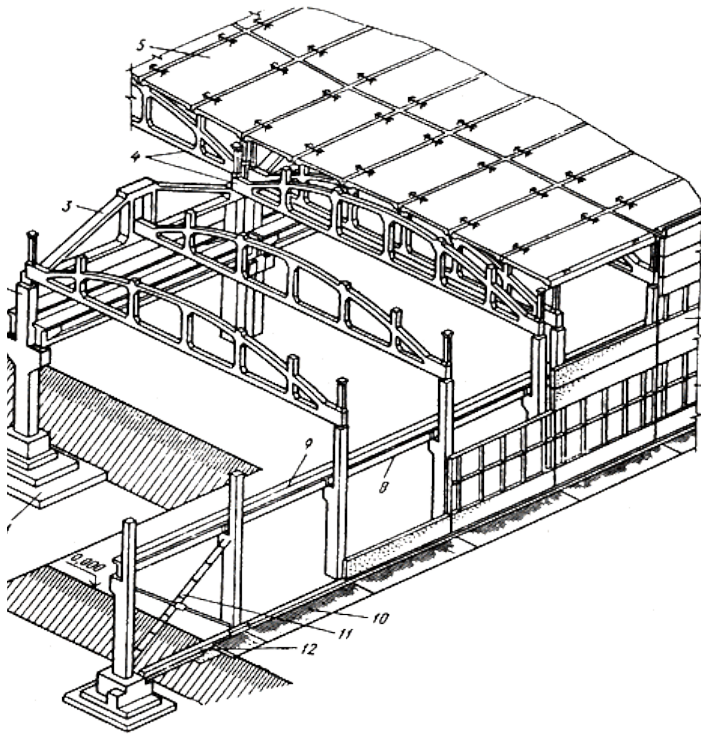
Одноповерхова промислова будівля із збірним залізобетонним каркасом:
